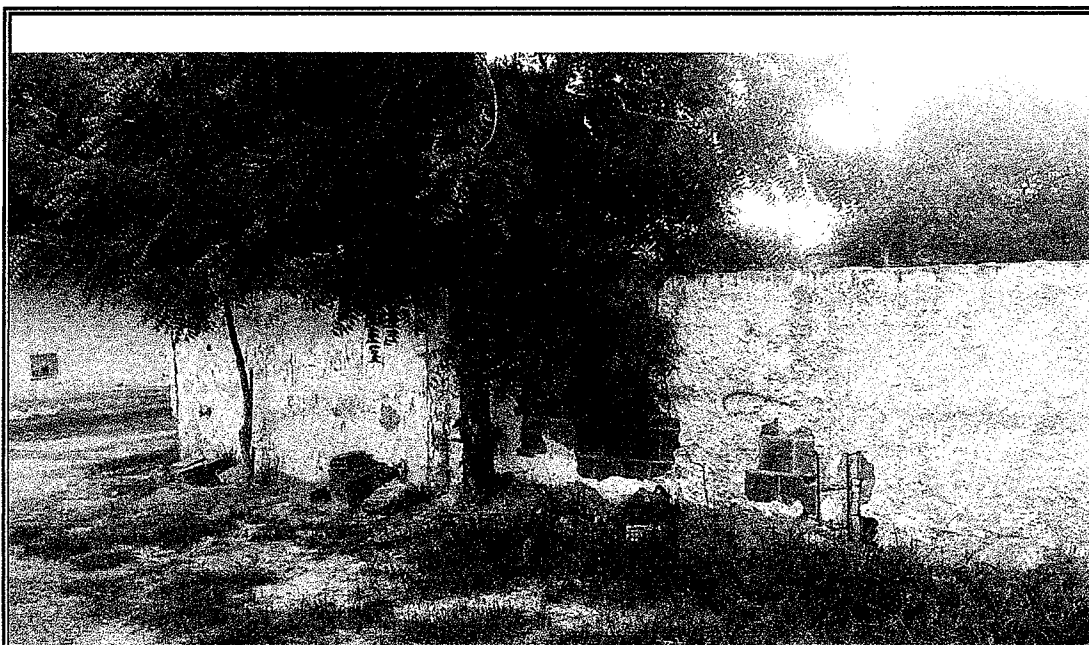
Vista do muro em que será reconstruido revestimentos e aumentado para atender a cobertura.
